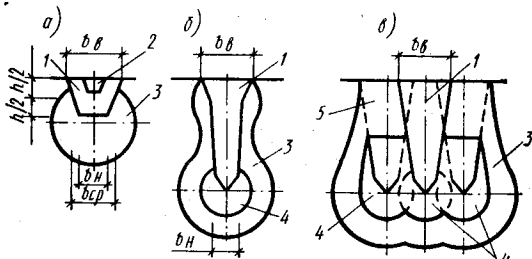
Фундаменты в вытрамбованных котлованах:
